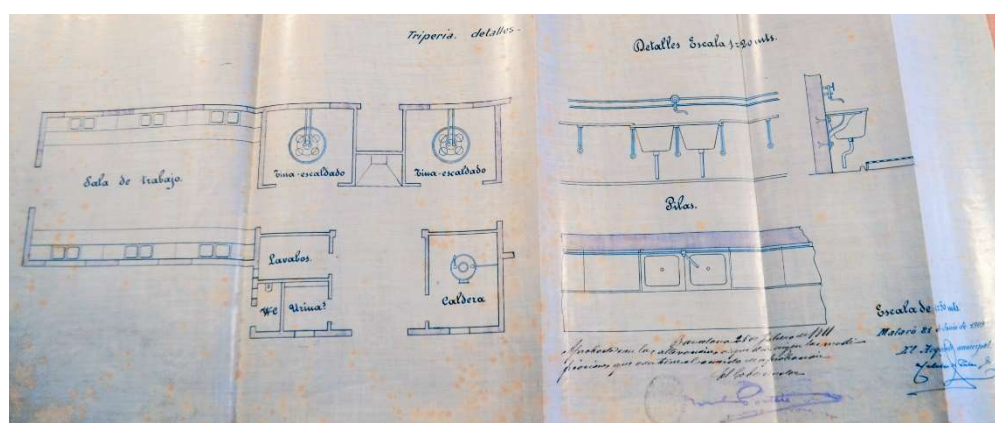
Plano de detalle del edificio de las triperías. [12]
